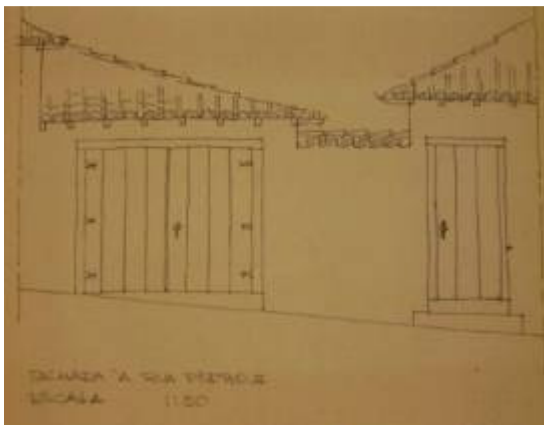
Fachada da garagem na Rua Dom Pedro II.
